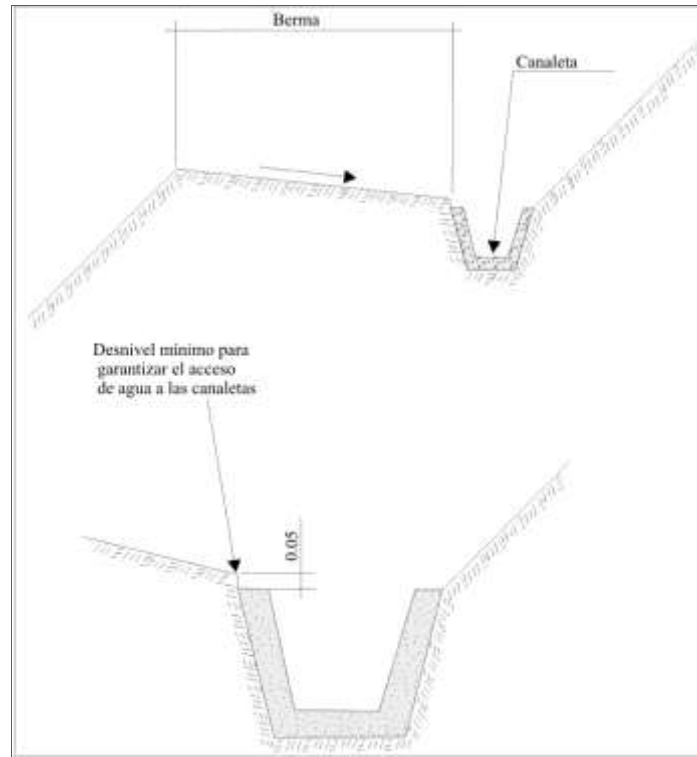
Detalle una canaleta de drenaje superficial (Zanjas de coronación).
